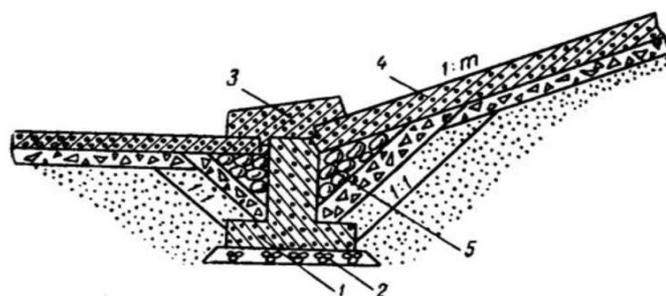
Пример упора для сборных железобетонных покрытий: 1 - сборные железобетонные упорные балки; 2 - подготовка из гравия или щебня; 3 - монолитный бетонный оголовок; 4 - плиты покрытия; 5 - обратный фильтр
